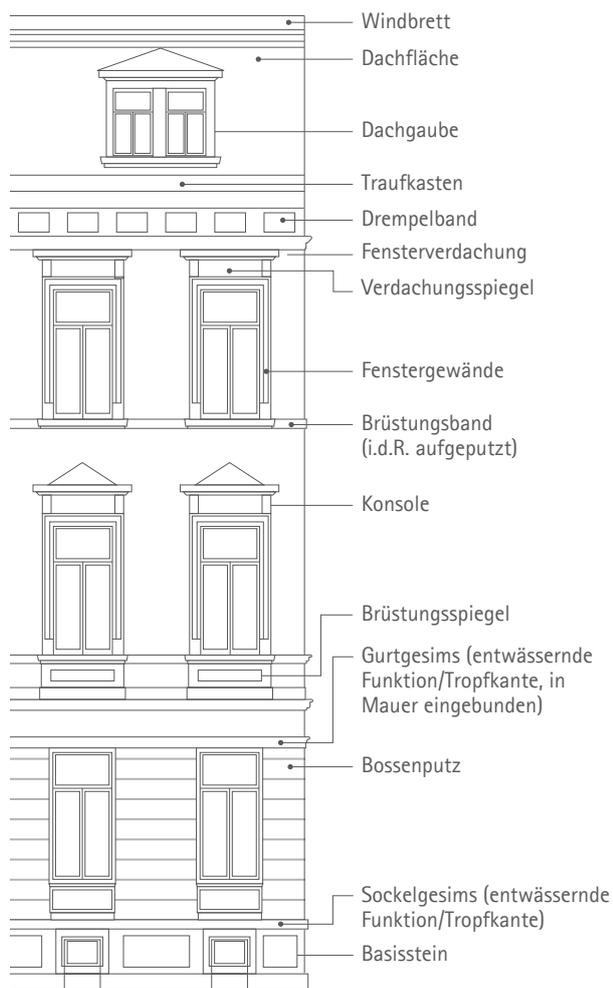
Fassadenelemente eines typischen Gründerzeitgebäudes
